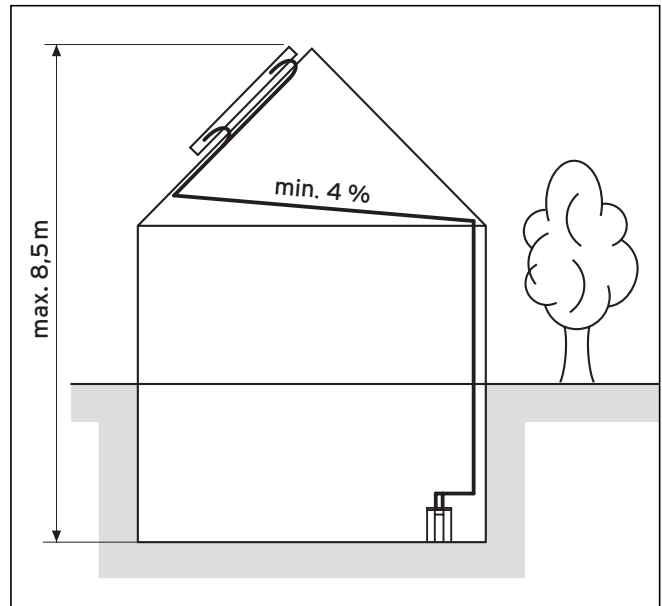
Высота монтажа и уклон трубопроводов без "бака обратной линии гелиоустановки"
